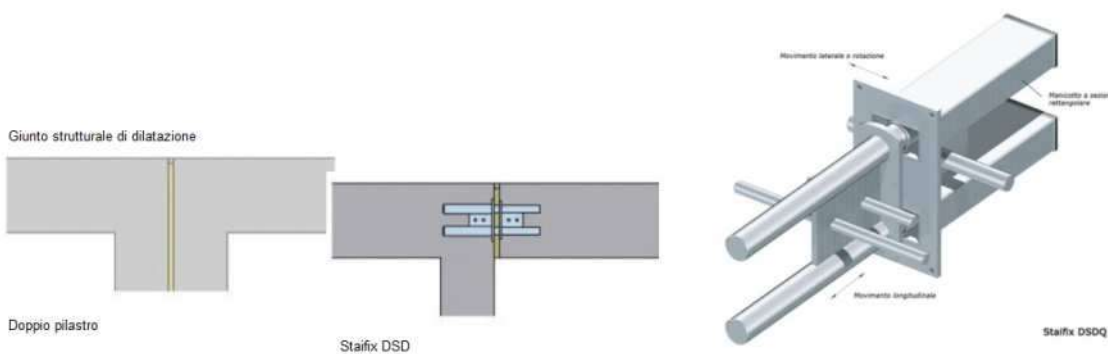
schema estratto dal catalogo STEFIX dove si evidenzia l'eliminazione del doppio pilastro
